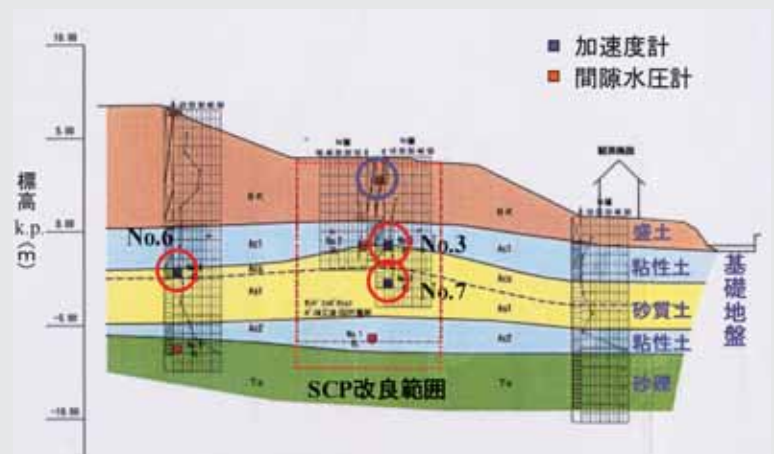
中下観測所付近堤防断面図及び間隙水圧計、強震計機器配置図
